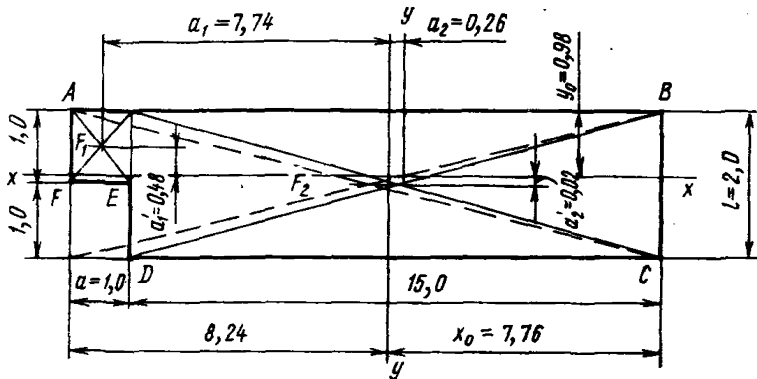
Схема к определению нормальных контактных напряжений в фундаментной плите конструкции
